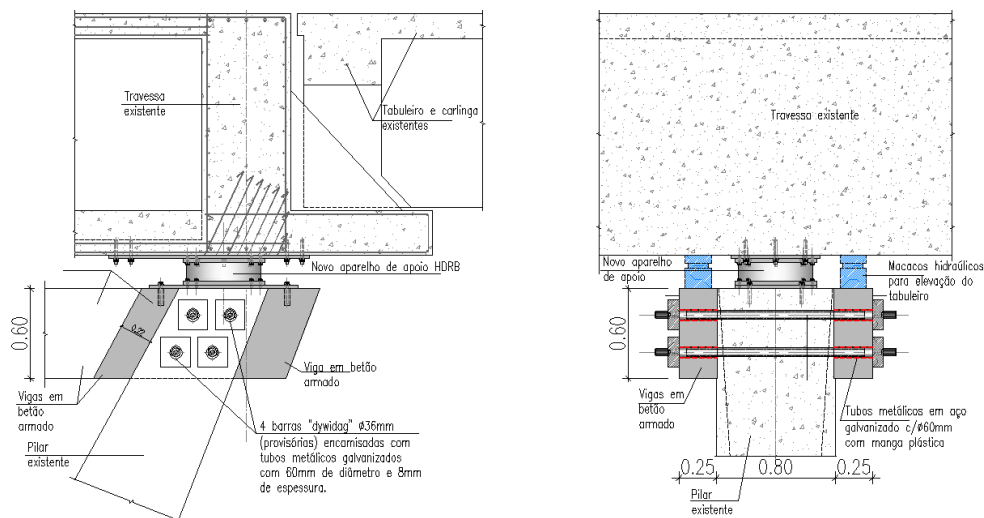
Pormenores para a montagem dos novos aparelhos de apoio
